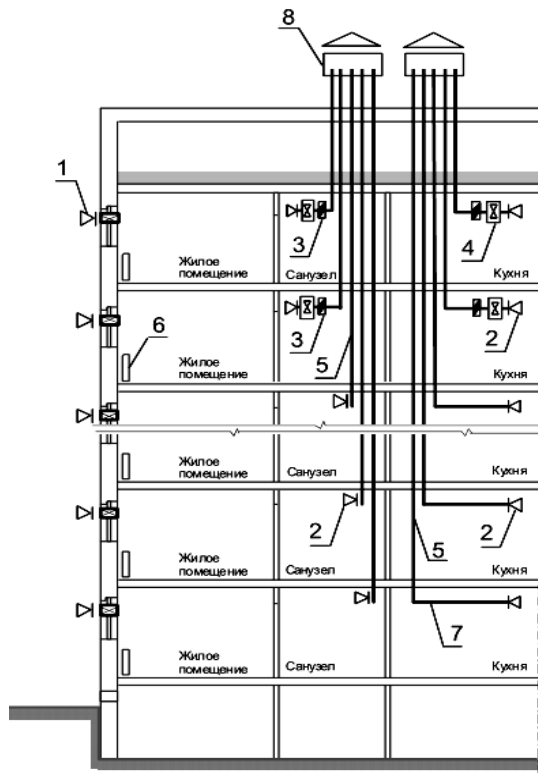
Система вентиляции жилого здания с естественным побуждением движения воздуха: 1 – приточное вентиляционное устройство; 2 – вытяжная вентиляционная решетка; 3 – обратный клапан; 4 – вытяжной вентилятор; 5 – вертикальный вентиляционный канал; 6 – прибор системы отопления; 7 – горизонтальный вентиляционный канал; 8 – дефлектор
